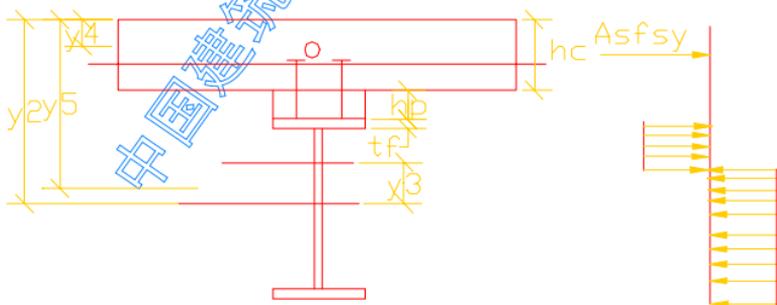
负弯矩时组合梁截面和计算简图
